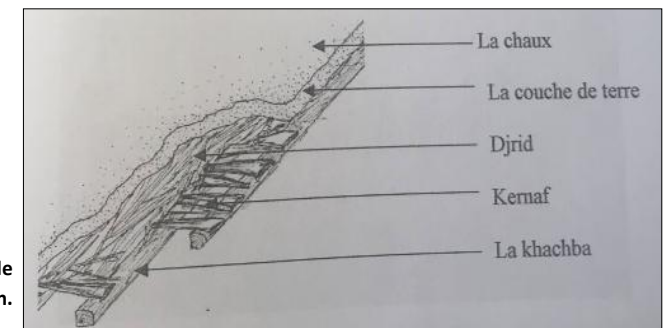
Détails de plancher timimounien. Source : Bouhalla.
